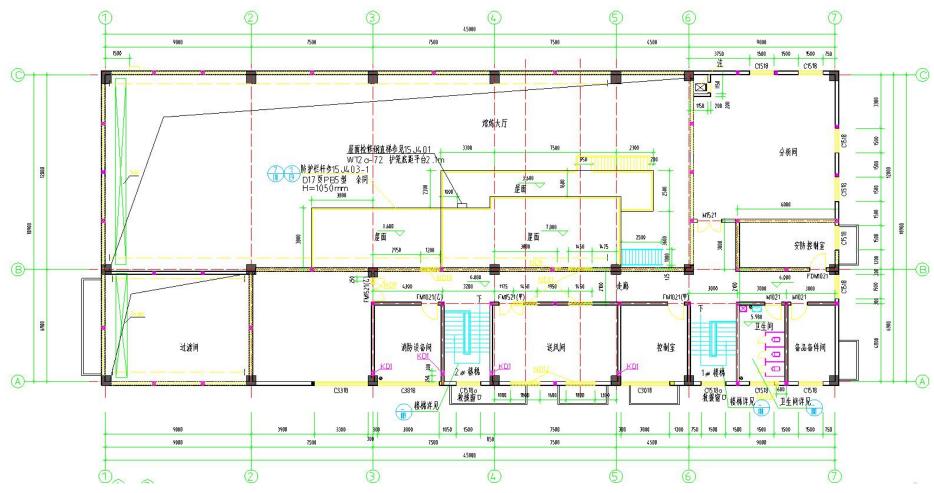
核电站废旧金属熔炼厂房二层平面布置图
